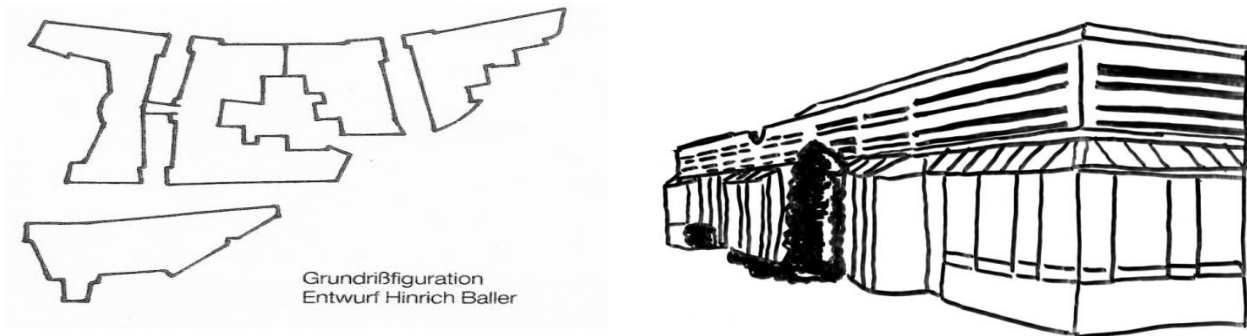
Grundriss und Fassadenansicht des Entwurfs 5.
